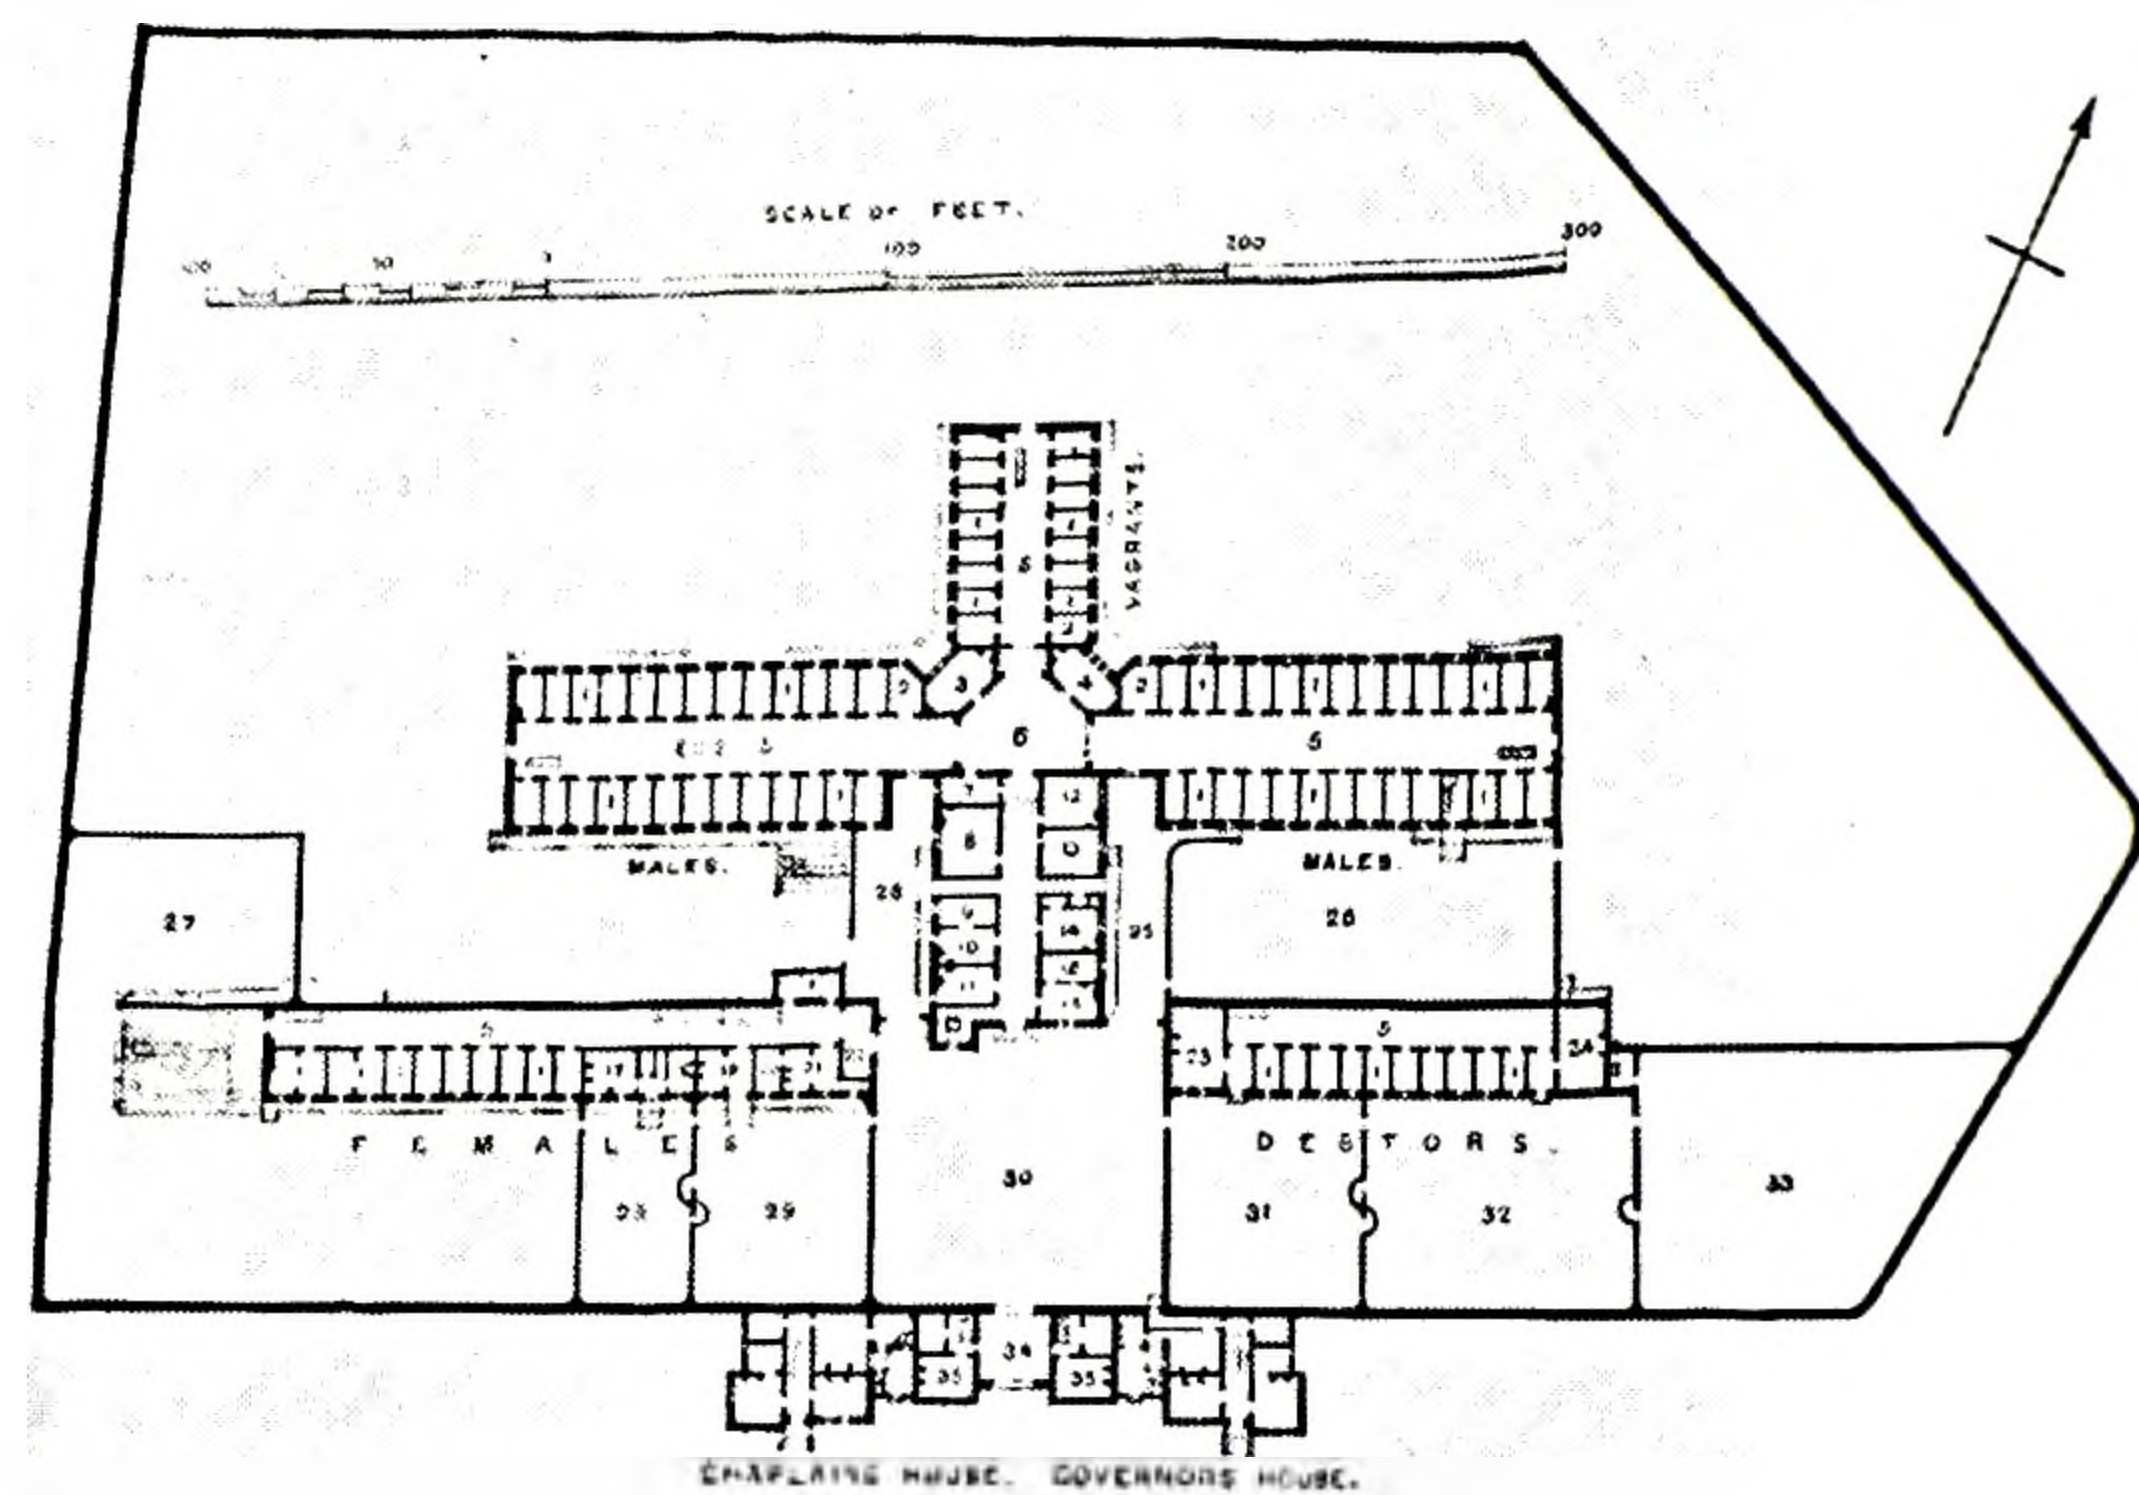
Plan de la prison de Lewes (Grande-Bretagne), construite en 1854. (Extrait de D.L. Howard, *English Prisons*).
